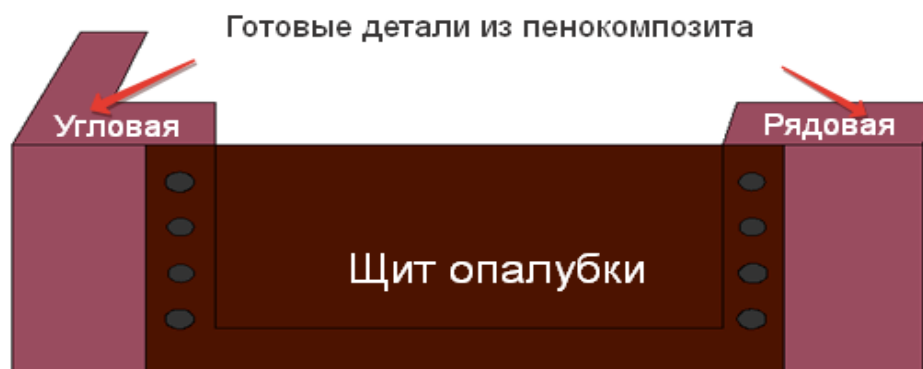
Закрепление опалубочного щита к готовым деталям
